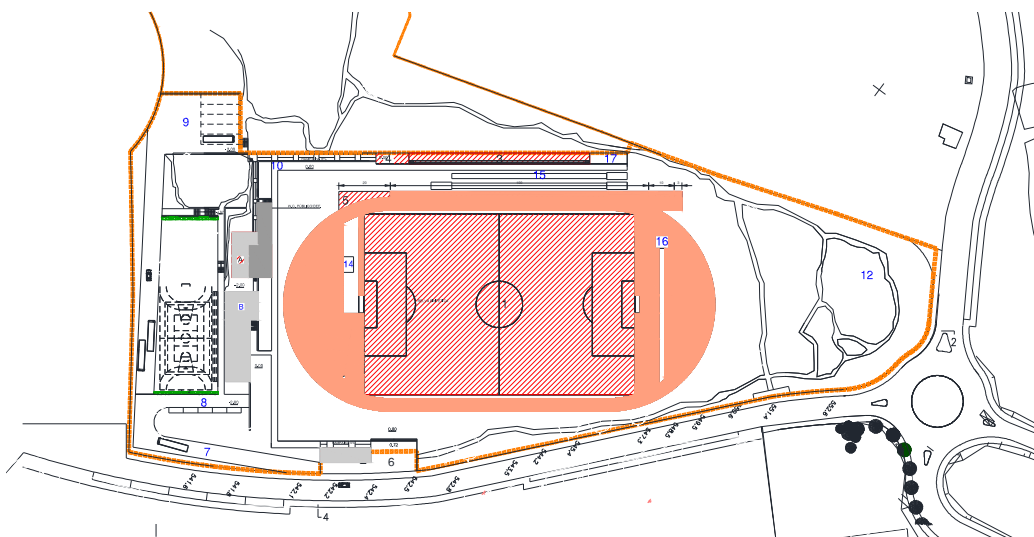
Planta geral do Centro de Formação Desportiva de Alfândega da Fé.
